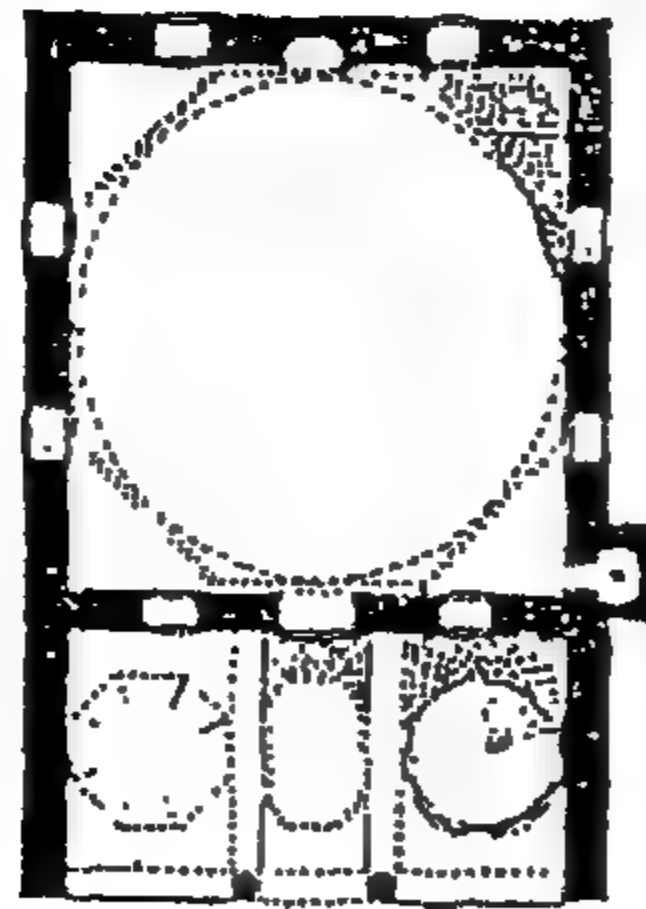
مسقط أفقي لدار الحديث في أدرنه (عن : أصلان أبا) .
